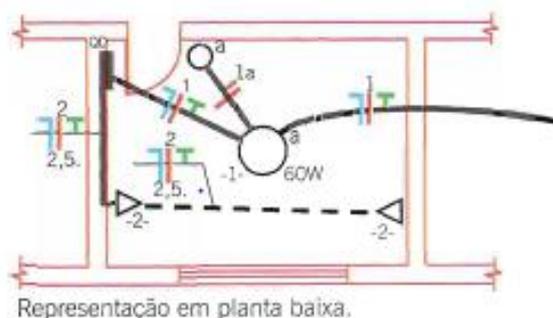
Exemplo de esquema unifilar em planta baixa.
